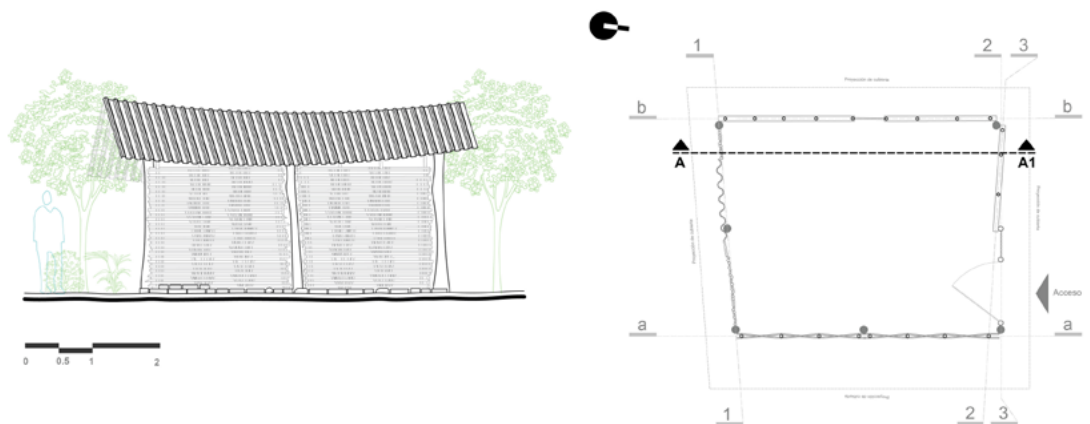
Alzado y plano arquitectónico de un módulo de vivienda de pajarete ubicado en la zona Valle del estado de Colima (Dibujos: Antonio Flores, 2017).
